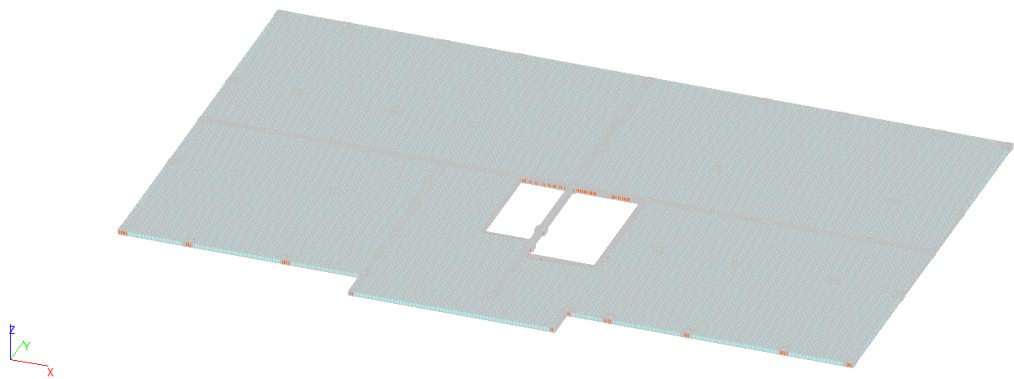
Расчетная схема плиты перекрытия в пространстве
